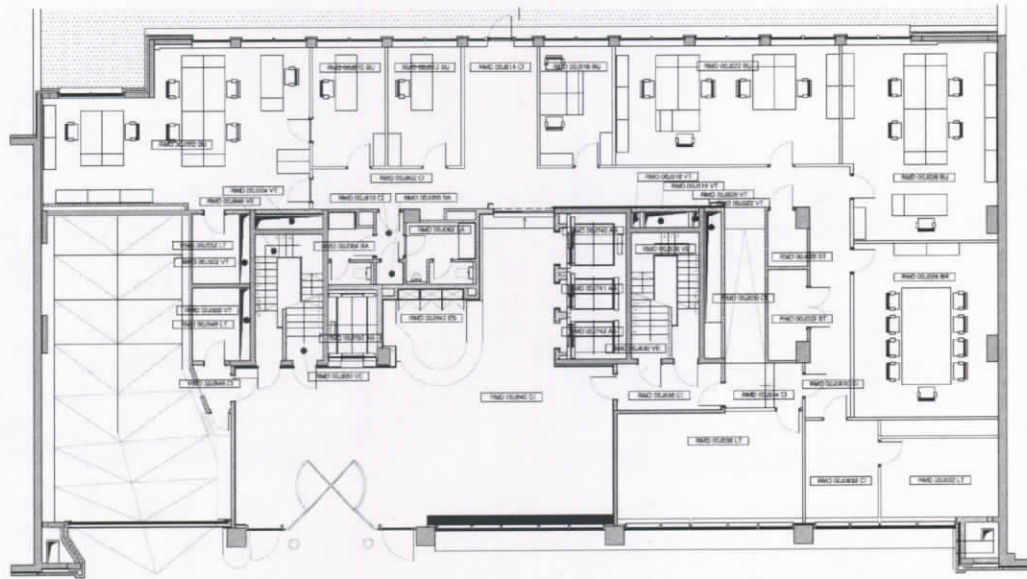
(a) : Plan du rez-de-chaussée du Bâtiment REMARD
